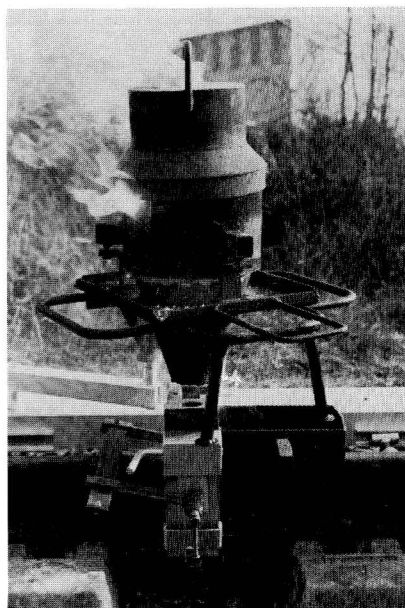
Coulée d'une soudure DELACHAUX
